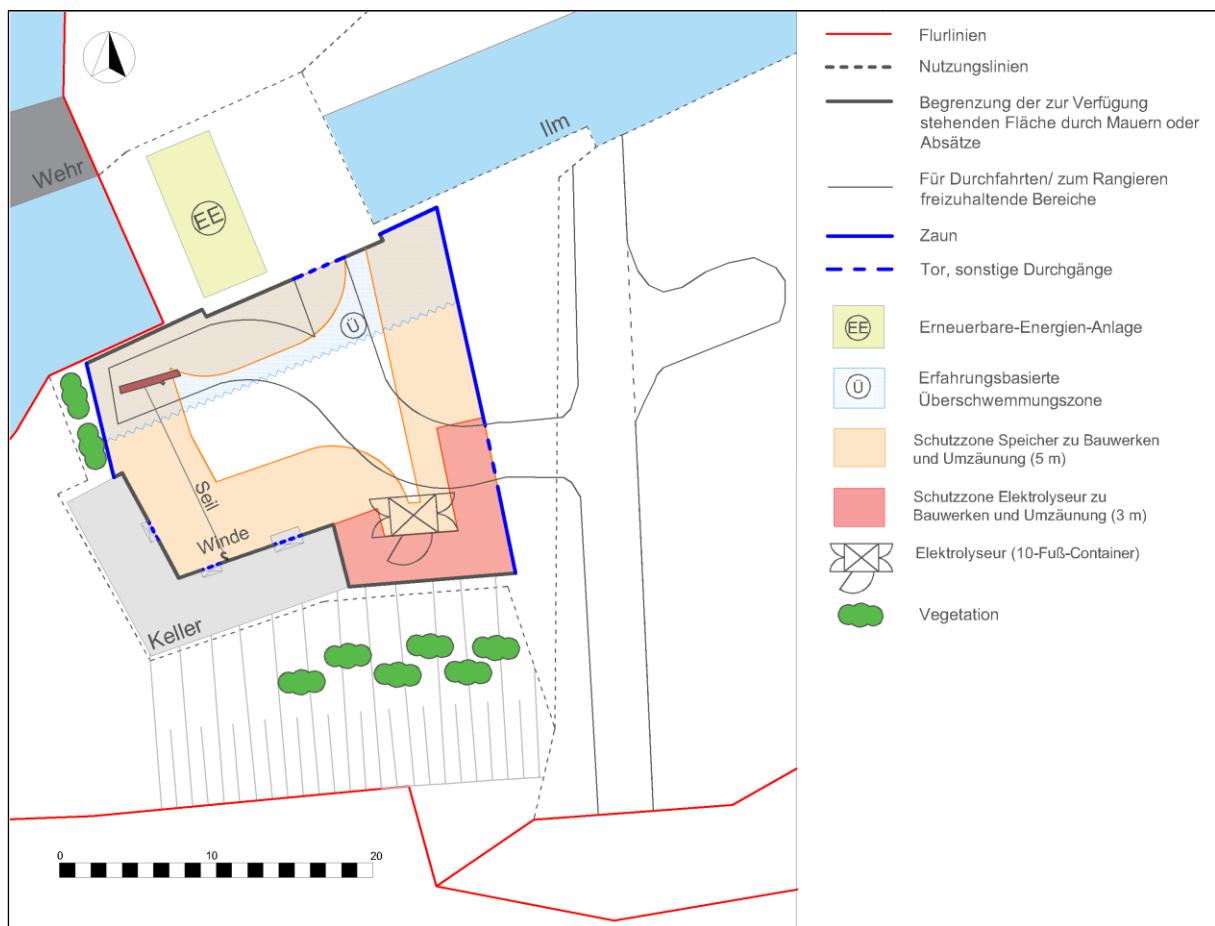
Lageplan der Kleinwasserkraftanlage in Oberroßla mit Schutz-zonen zur Berücksichtigung der Sicherheitsabstände gemäß TRGS 751
